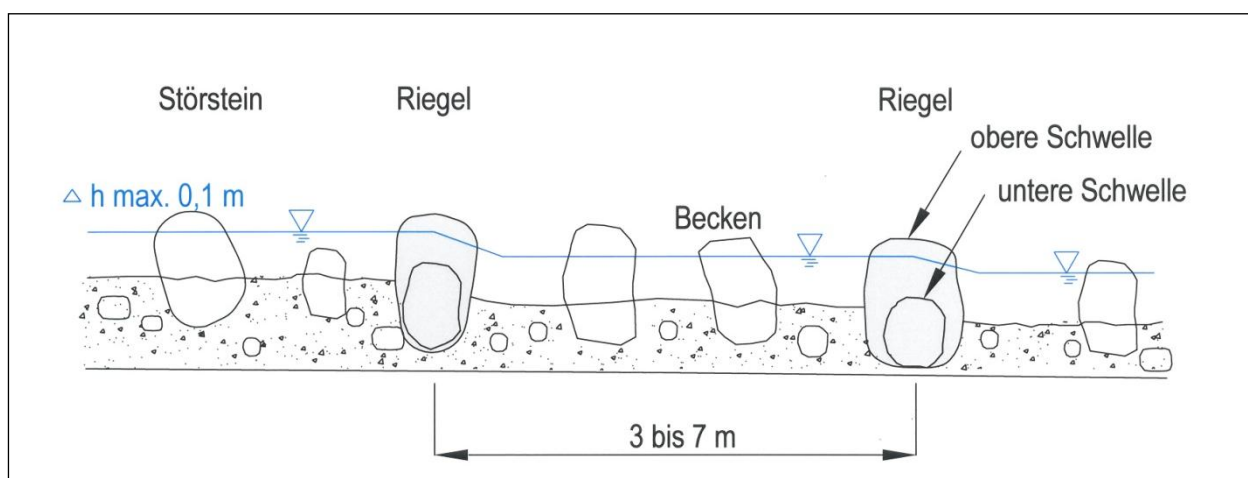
Prinzipschema Beckenpass mit aufgelösten Steinriegeln (Längsschnitt)
